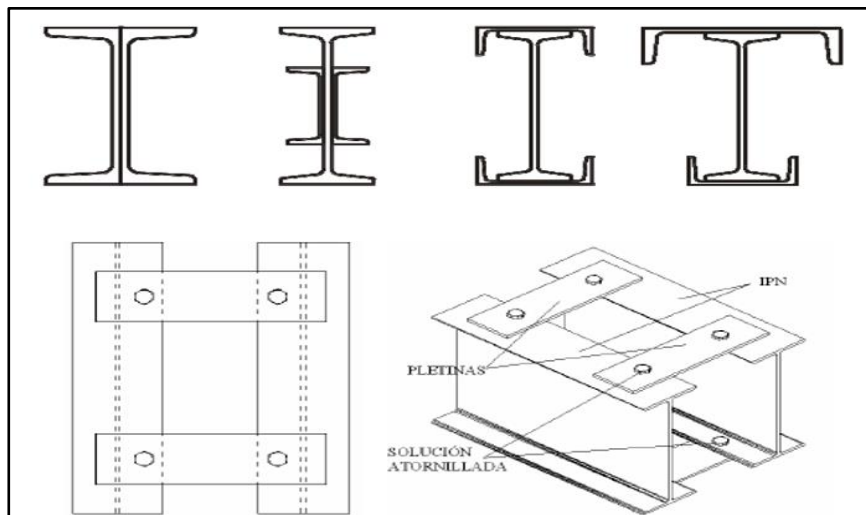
Vigas de alma llena múltiples. Brotóns (2006)
